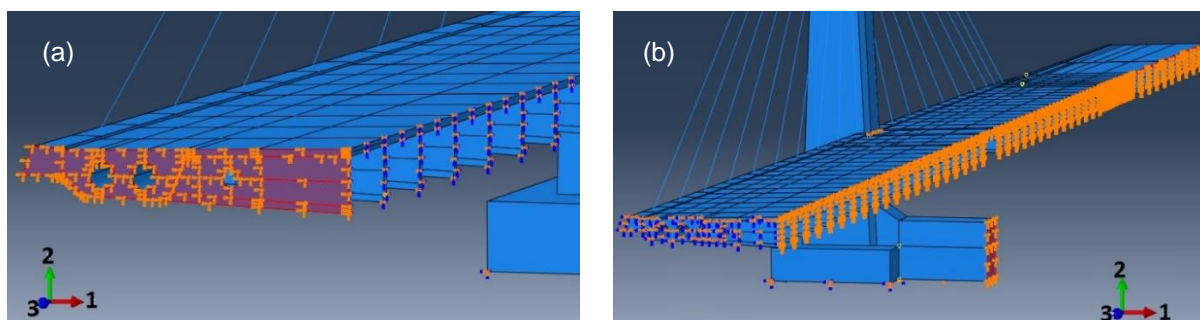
Facetas do tabuleiro onde se aplicaram as condições de fronteira para definir as simplificações de simetria segundo o plano 1-2 (a) e o plano 2-3 (b).
